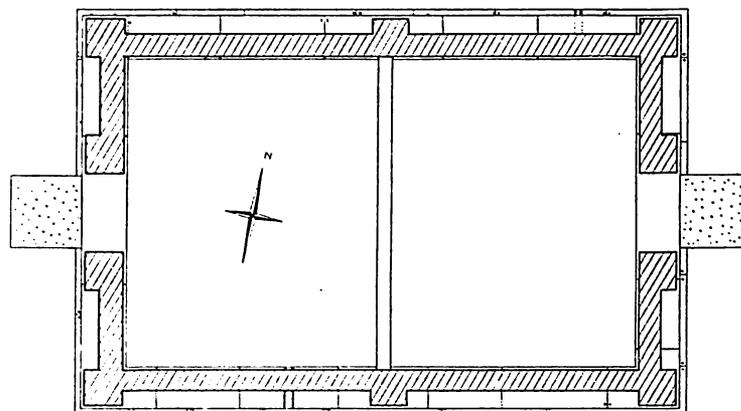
Épidaure. Sanctuaire Y. Plan restauré.
